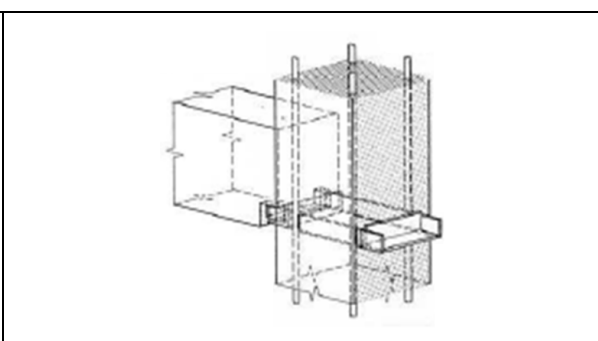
Ligação por consola curta metálica (Stupré, 1981)
